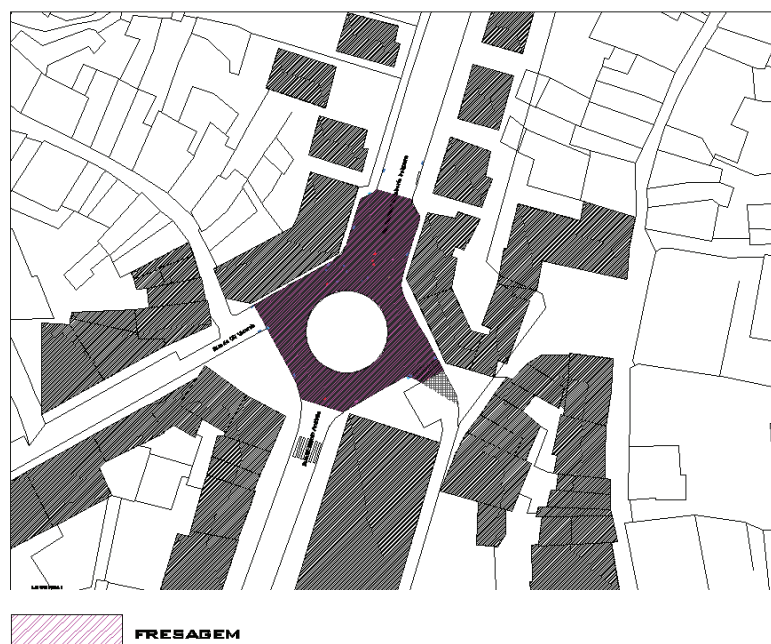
Trabalhos de pavimentação no Largo Navarro de Andrade.
